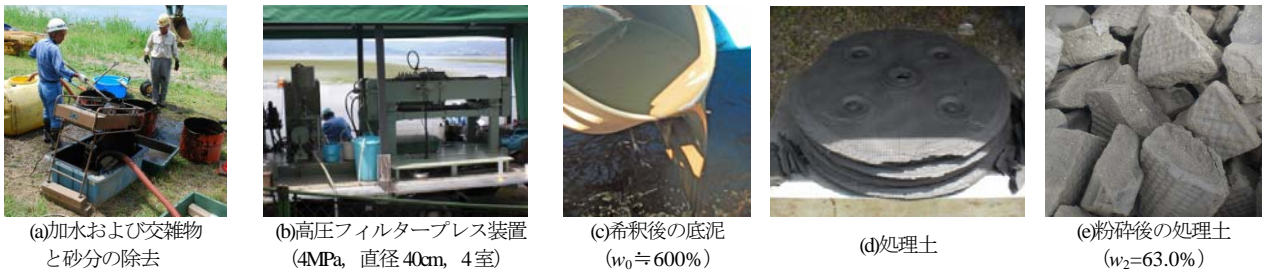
4MPaの高圧フィルタープレスによる脱水の概略
